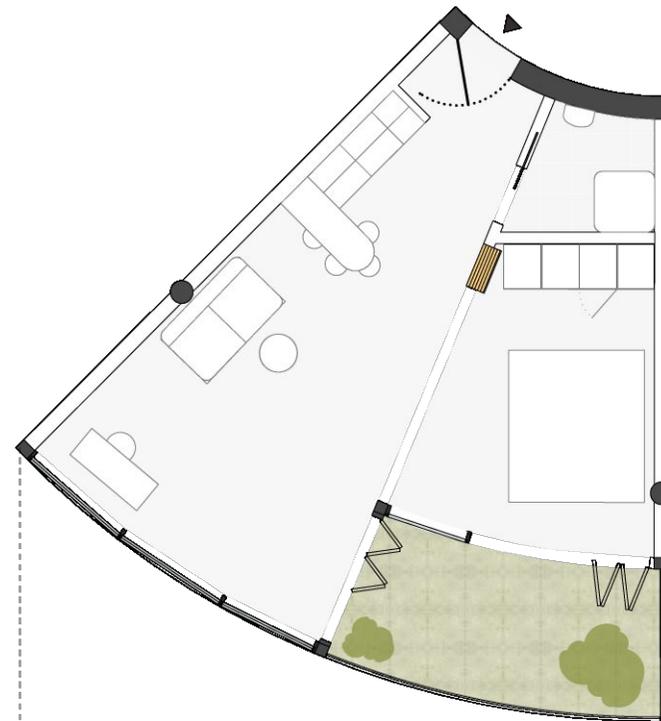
Grundriss Wohnung Typ A.b, offen
